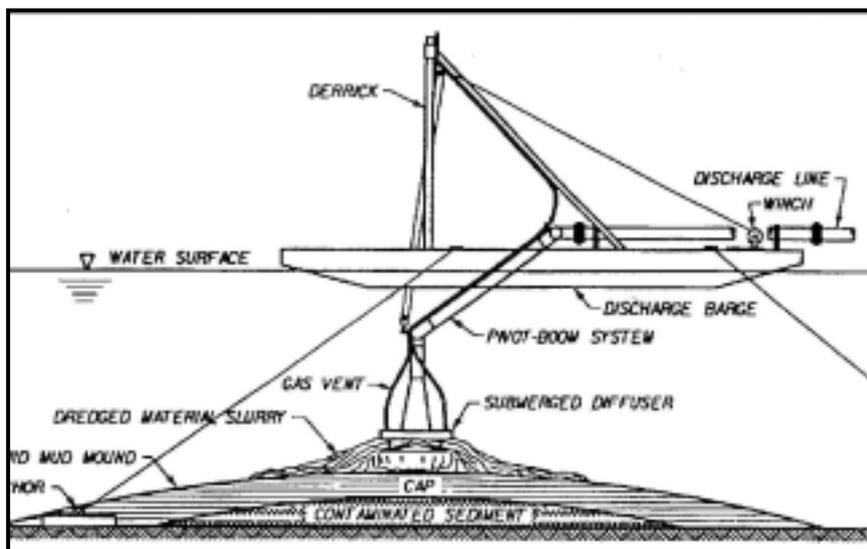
覆蓋作業施工駁船設備配置示意圖
